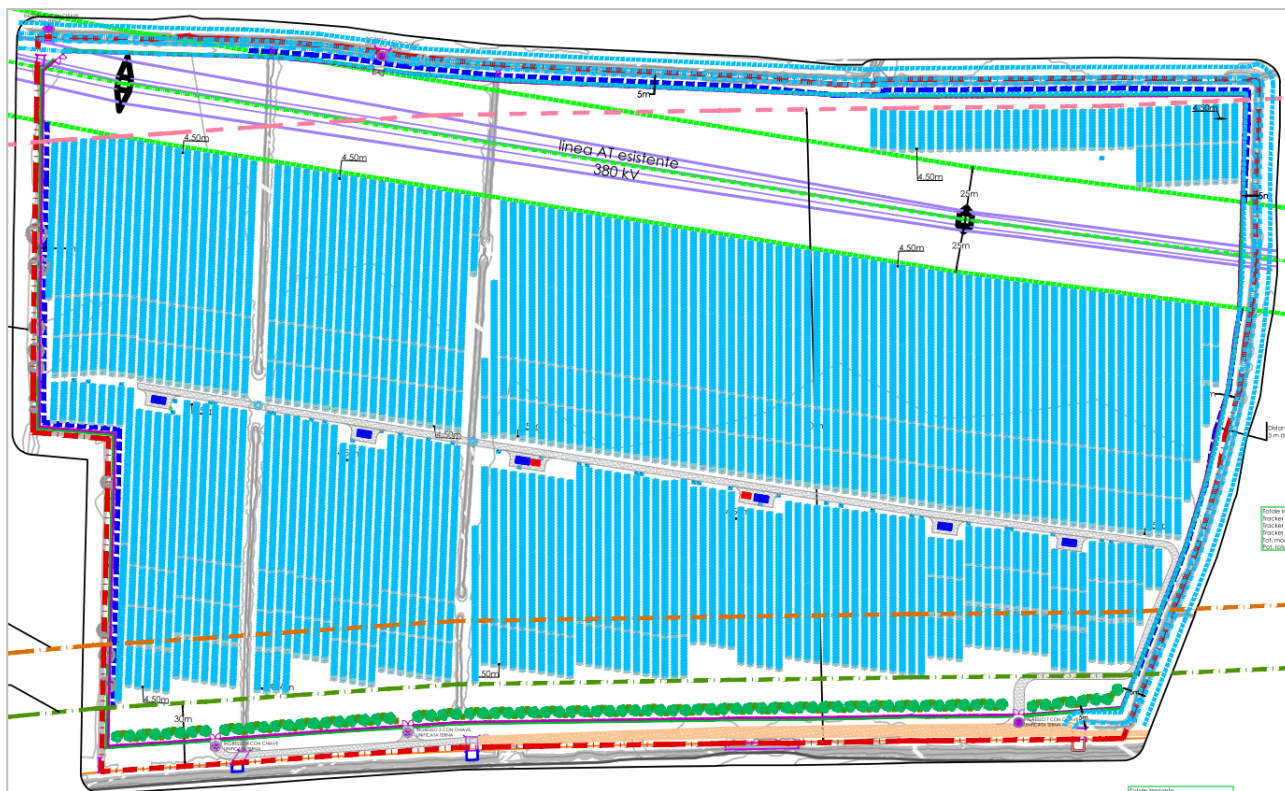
Planimetria di dettaglio dell'Area Nord dell'Autostrada A21
